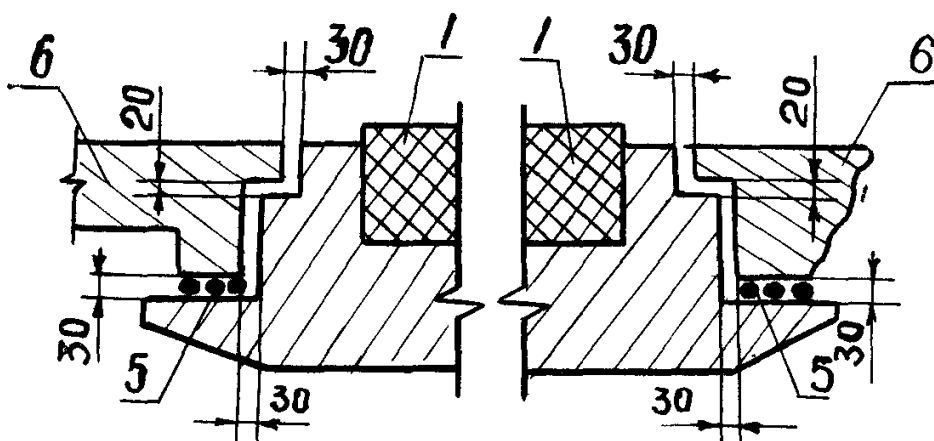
Схема зазоров при стыковке блока горелок к обмуровке топки
